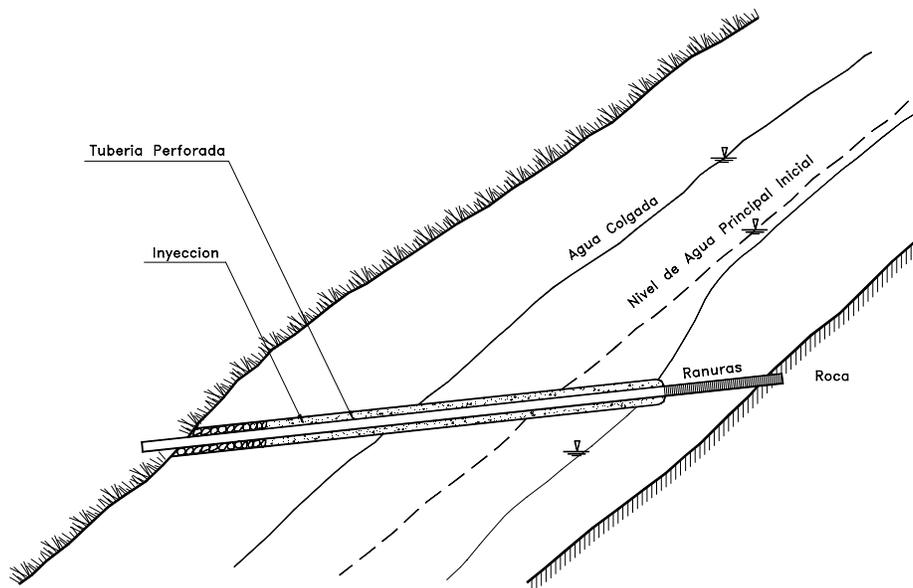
Subdren de penetración diseñado para captar solamente en la punta interior.
